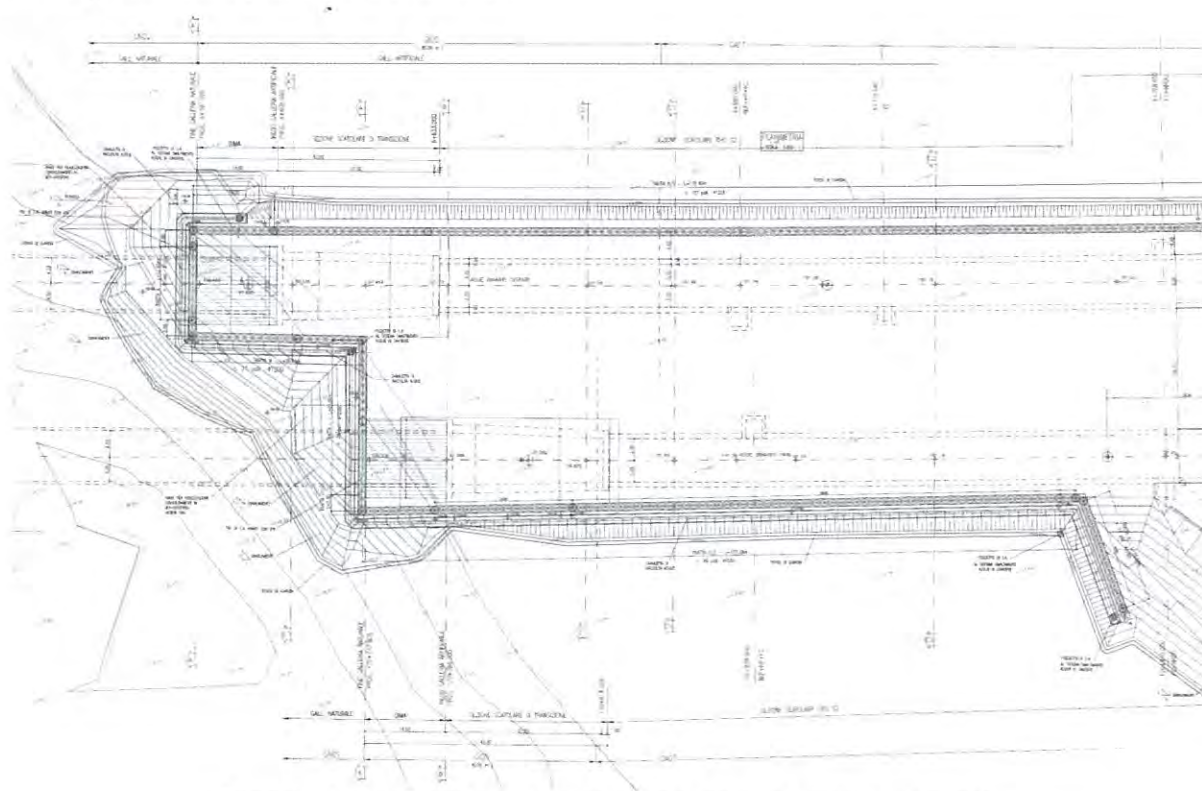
Planimetria della zona di imbocco nella galleria naturale
